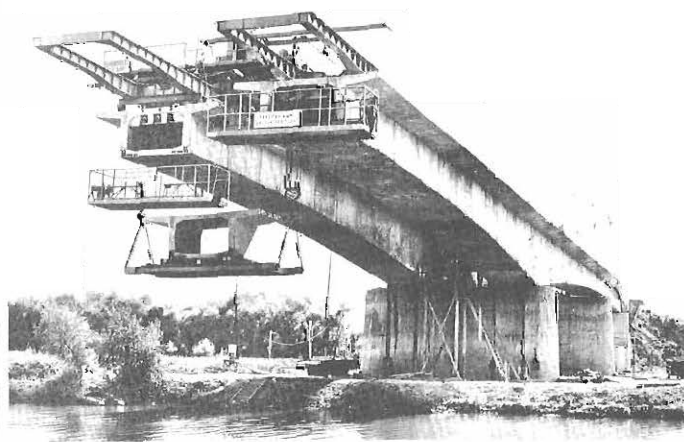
Vista de uno de los puentes durante su construcción.
